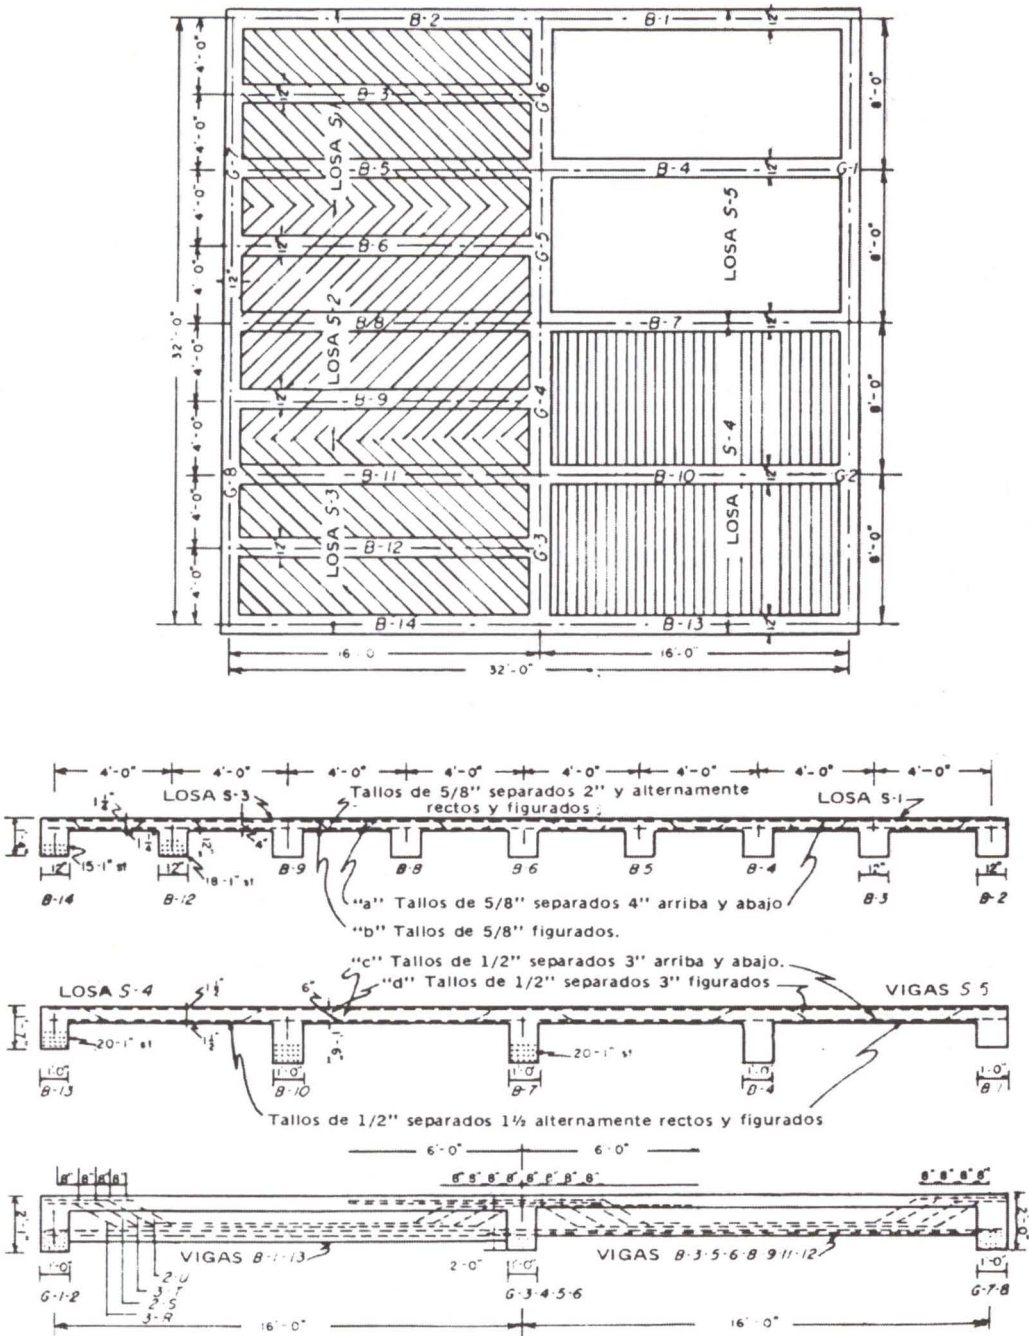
Refuerzo de losas y vigas, edificio de carpintería (concreto reforzado con bambú, Clemson Agricultural College).
